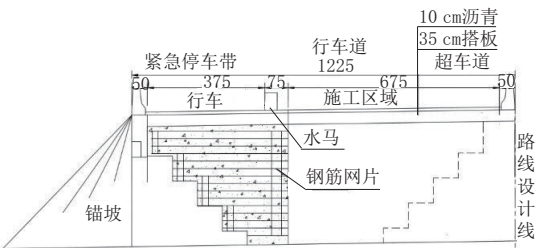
右侧基坑开挖及轻质混凝土浇筑(单位:cm)
